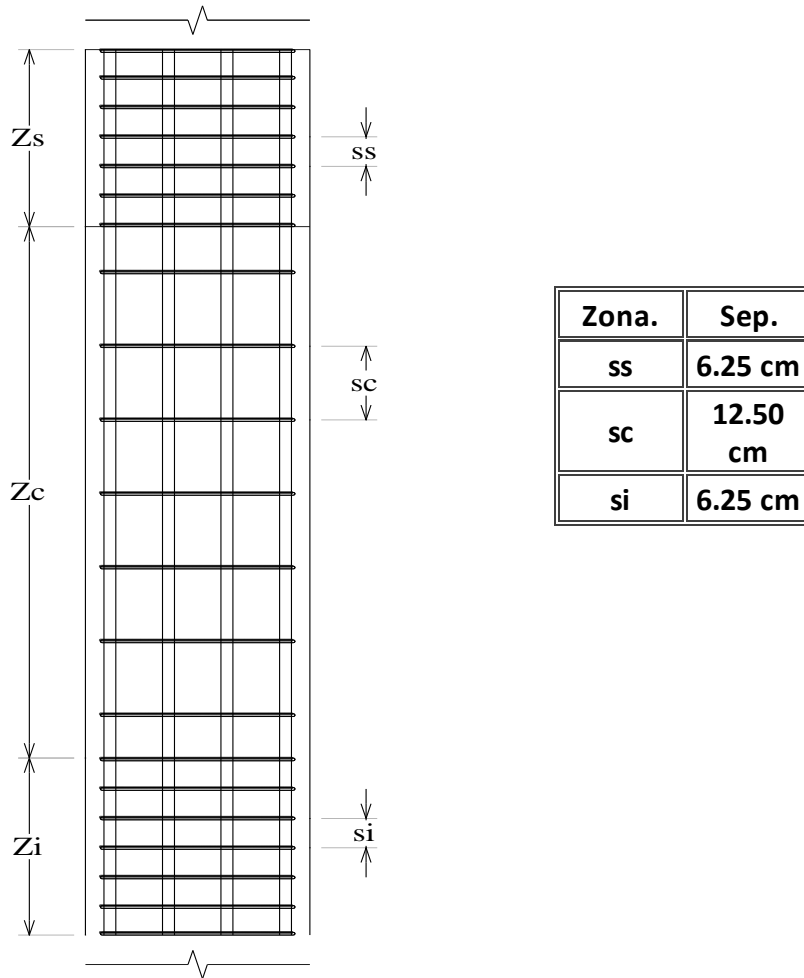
Configuración del armado del acero transversal, estribos, en la zona de confinamiento.
